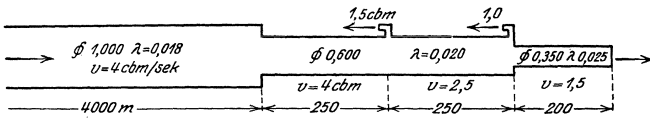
Rohrleitung für Tunnellüftung mit abgestuften Weiten.
